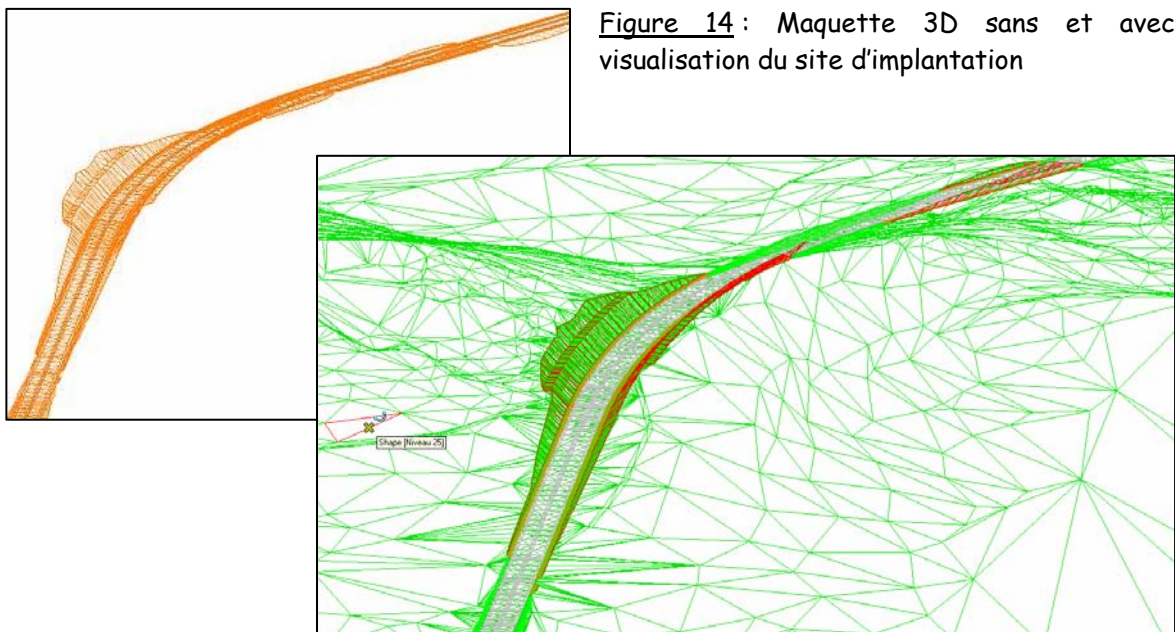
Maquette 3D sans et avec visualisation du site d'implantation
